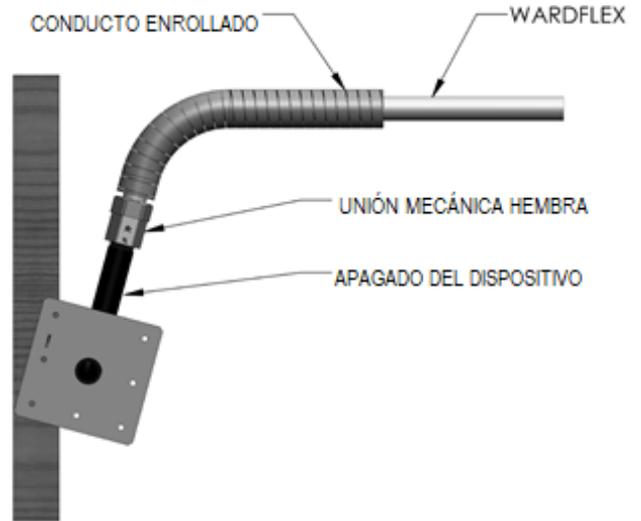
Desconexión del aparato con un accesorio mecánico hembra WARDFlex®/ WARDFlex®MAX que se puede instalar en un lugar oculto. Para este tipo de arreglo, consulte la sección 4.4 sobre detalles de protección.
